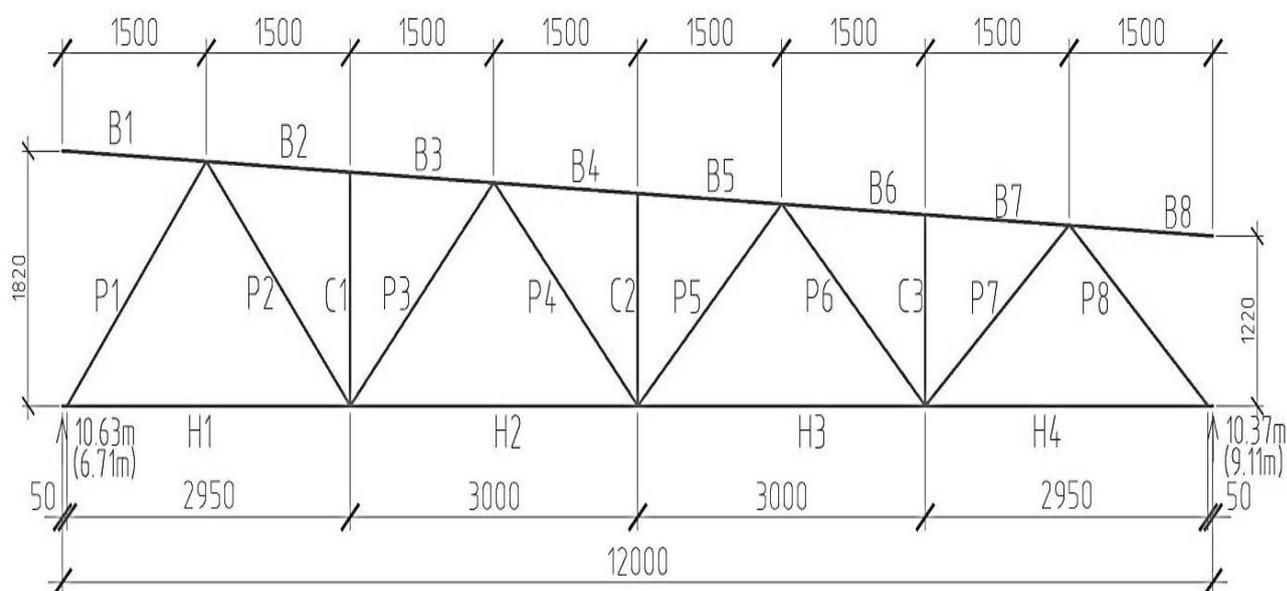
Геометрическая расчетная схема поперечной рамы
